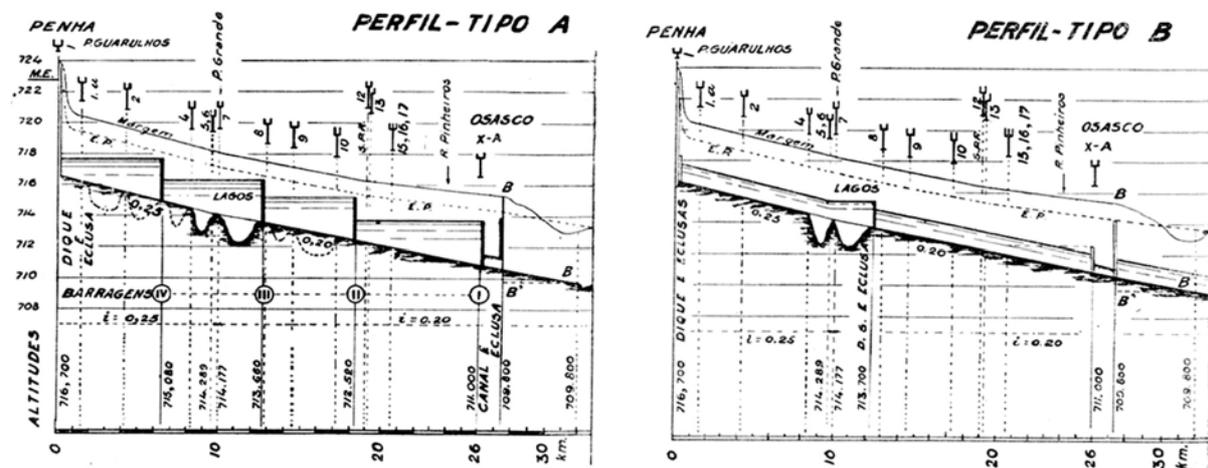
Perfil Longitudinal para as seções transversais Tipo A e Tipo B. Observar que a seção Tipo A/ Canal Central necessitaria de diversas barragens para controle da vazão, enquanto no perfil da seção Tipo B/ Duplo Canal são apontadas duas barragens.
